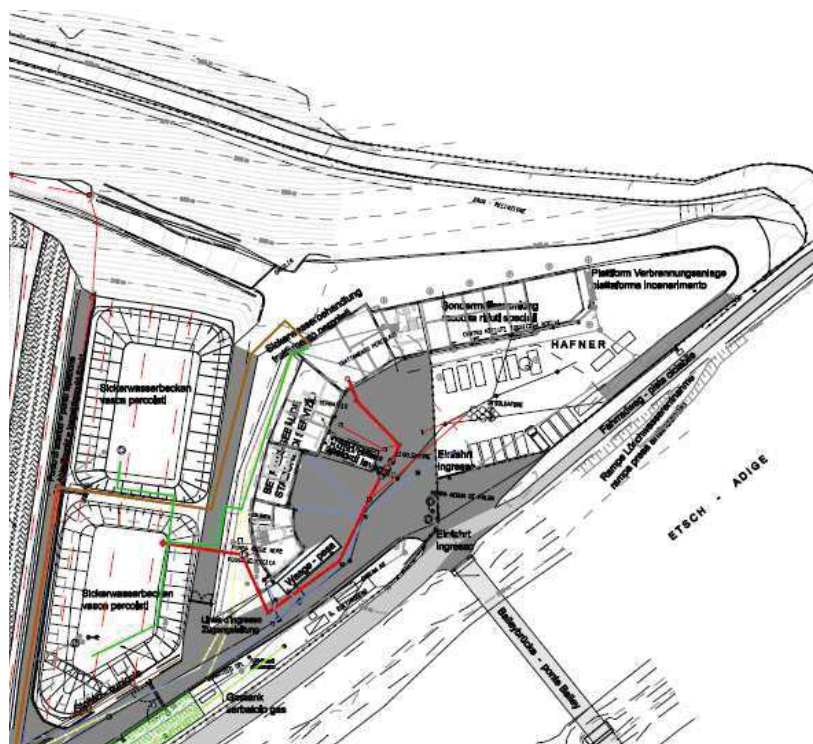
Estratto planimetria della discarica di Vadena soggetta ad AIA. L'Area R&S non rientra nell'AIA.
